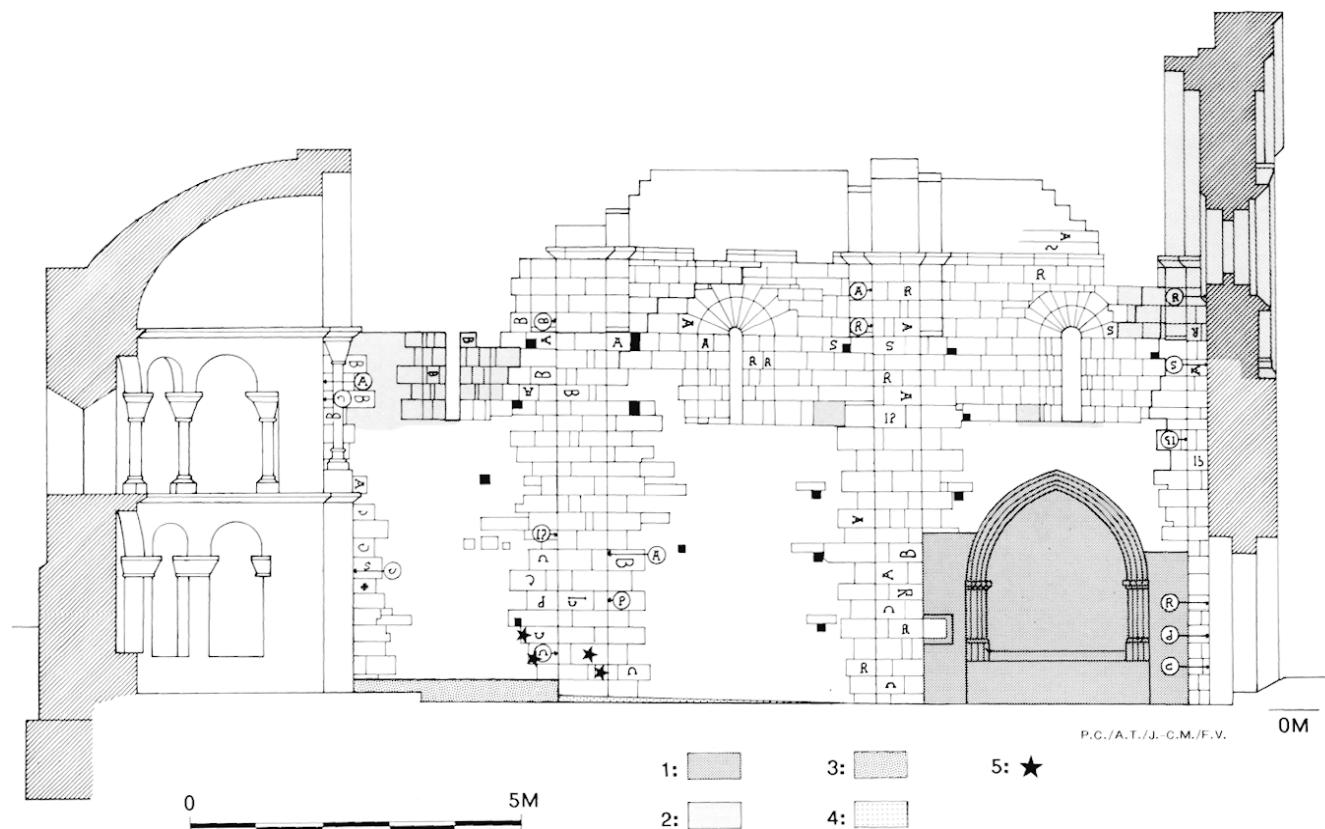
Elévation interne du mur goutterot sud. 1 - Restaurations, adjonctions anciennes. 2 - Restaurations de 1946-53. 3 - Banquettes latérales. 4 - Fondations. 5 - Moellons au marteau taillant bretté.
